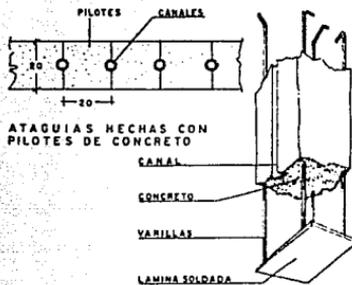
ATAGUIAS DE PILOTES DE CONCRETO
